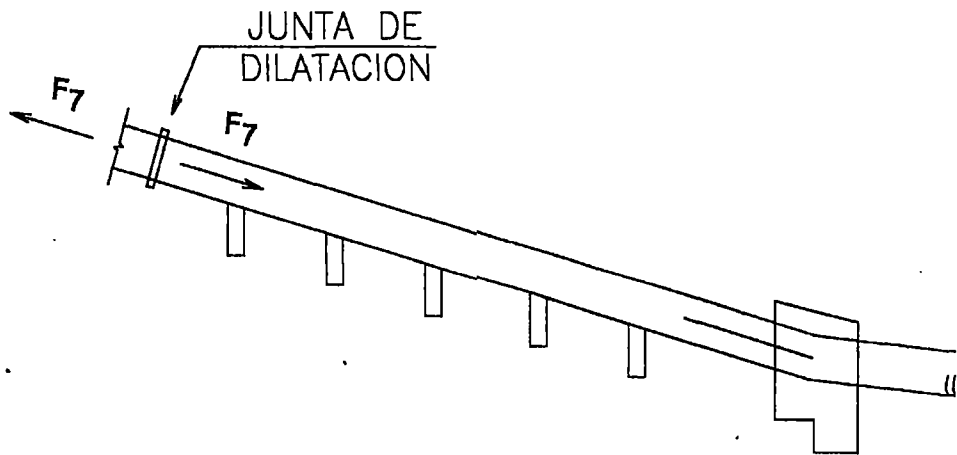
Fuerza F_7 para el diseño de los anclajes
